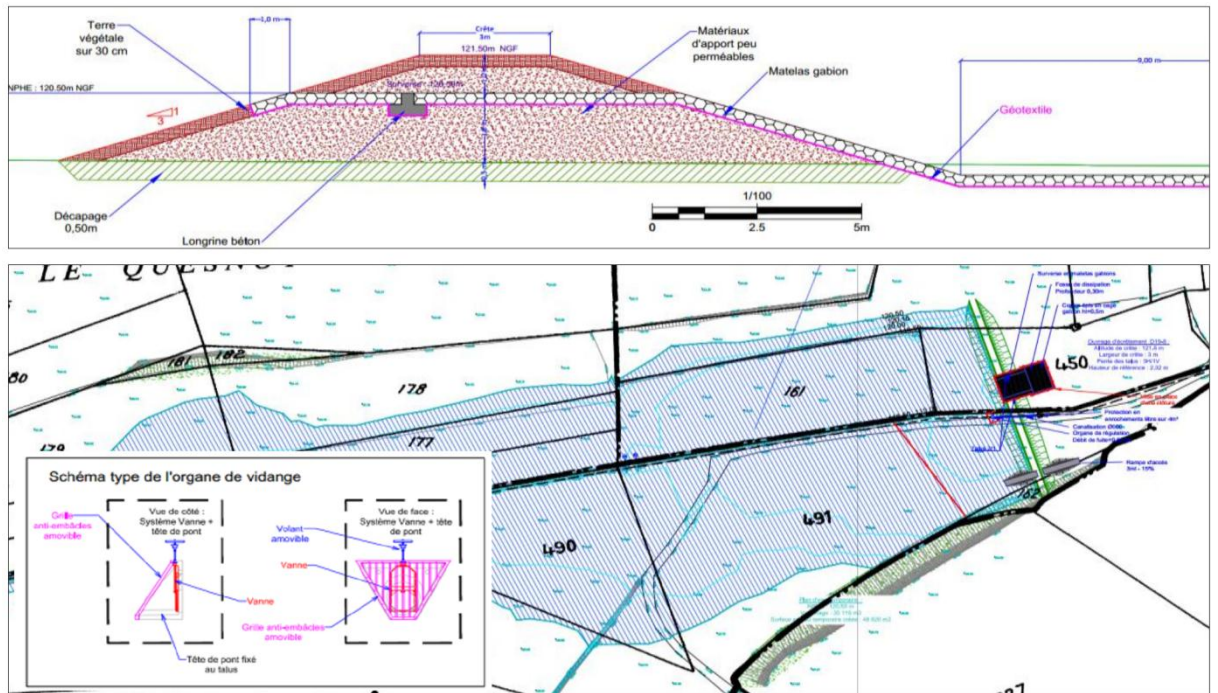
Extrait du plan de masse – Ouvrage D19-8
